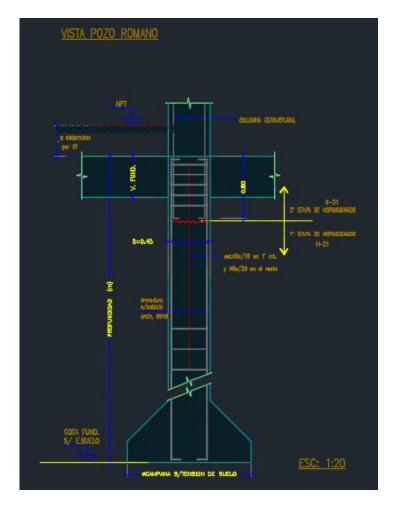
Detalle de los pozos y pilotes de fundación – proyecto parque este
